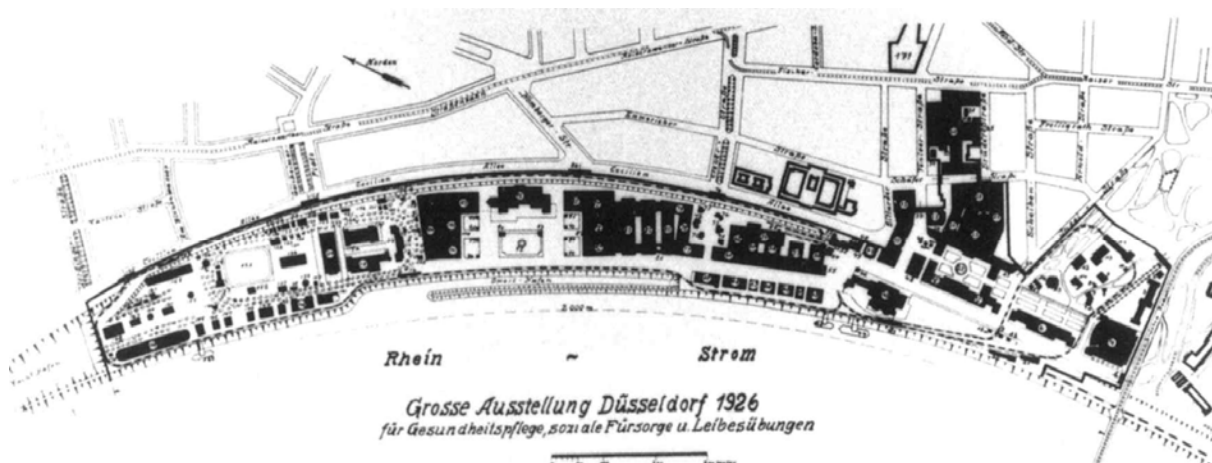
Lageplan der Ausstellung GESOLEI, 1926
